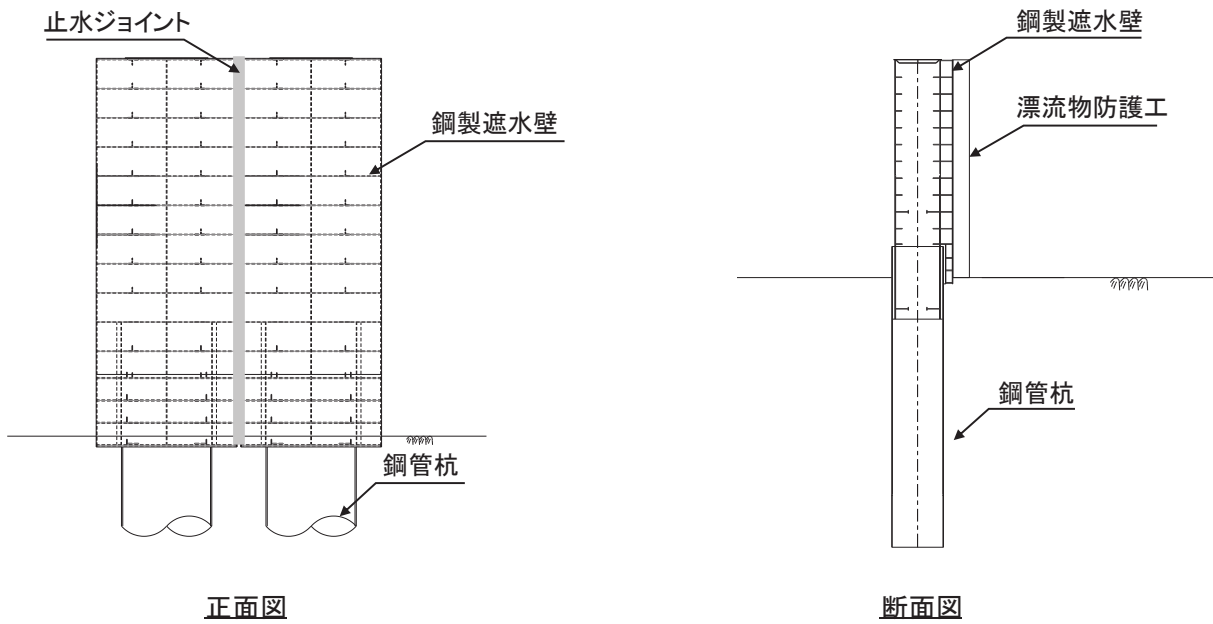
10. 2-26 鋼管式鉛直壁（岩盤部） 正面図及び断面図（Ⅱ区間）
